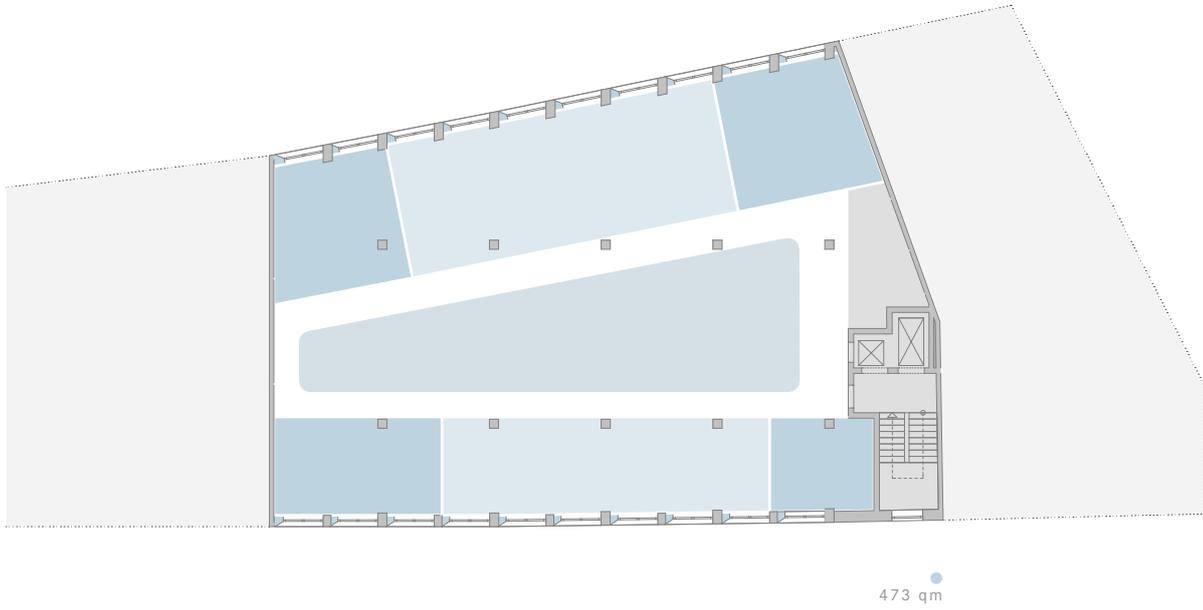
Grundriss Umbau - Nutzungseinheiten
